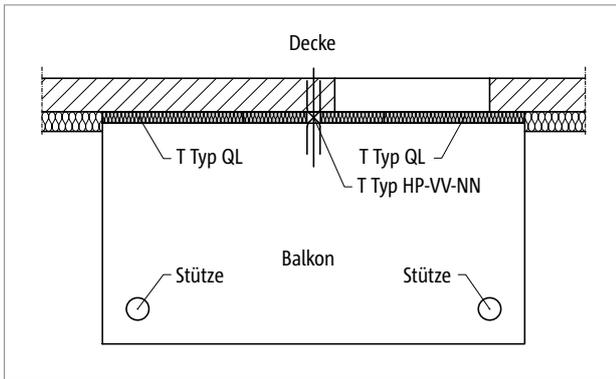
Schöck Isokorb® T Typ HP: Balkon mit Stützenlagerung
